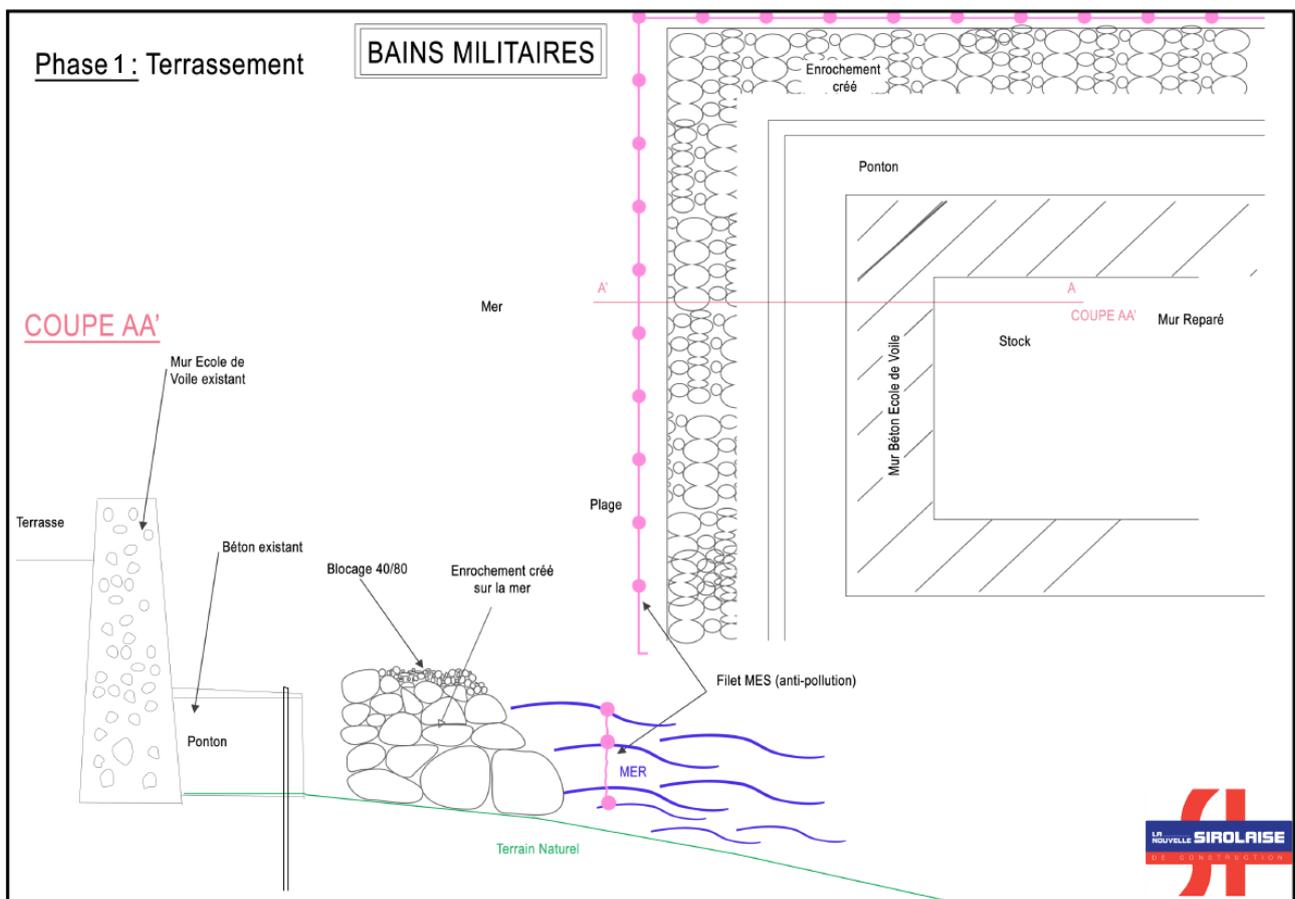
Plan de coupe des travaux de phase 2 - étape 1 (source : La Sirolaise)
